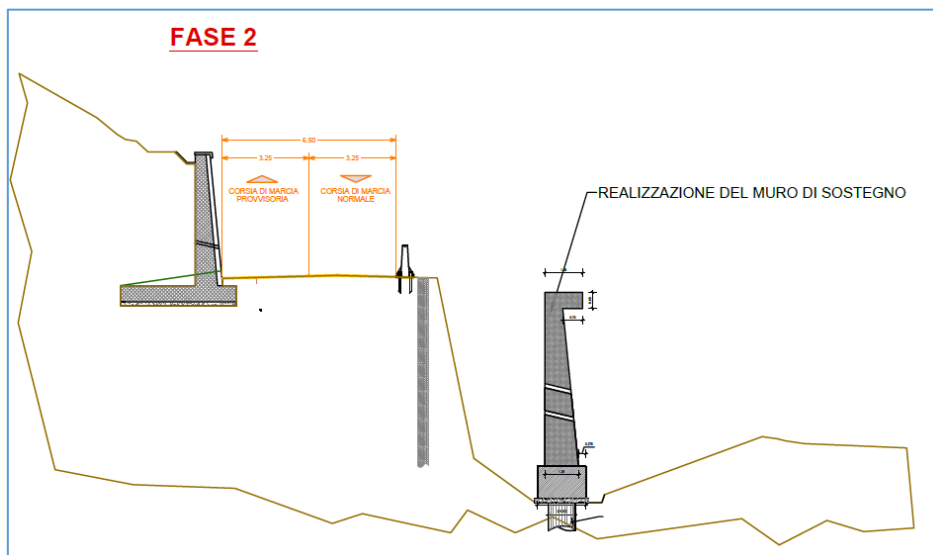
c–Sezione tipo 2 – Fase di realizzazione nuovo muro di sostegno
